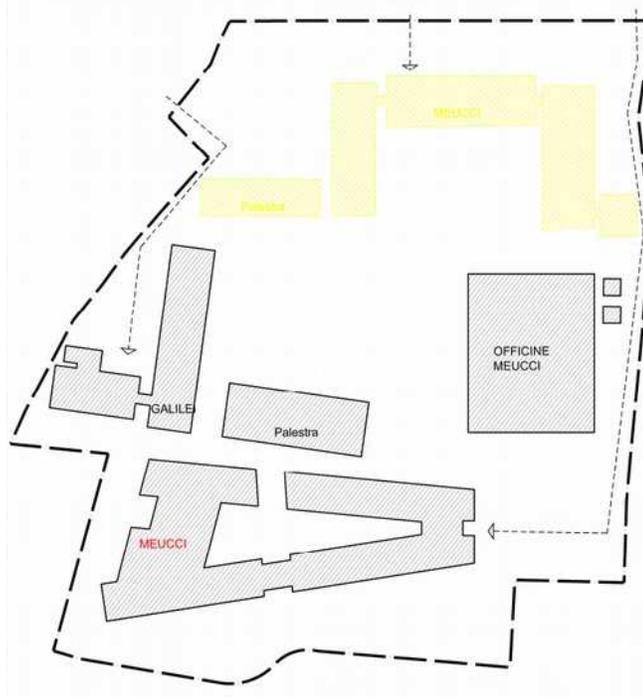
Schema FASE 3a demolizione Istituto Meucci
